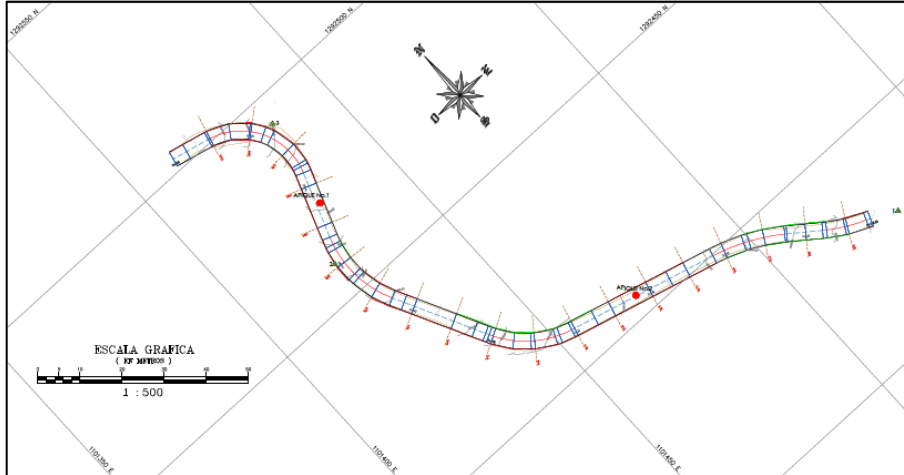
Imagen de planta del tramo 4 del proyecto de Rionegro-Santander
